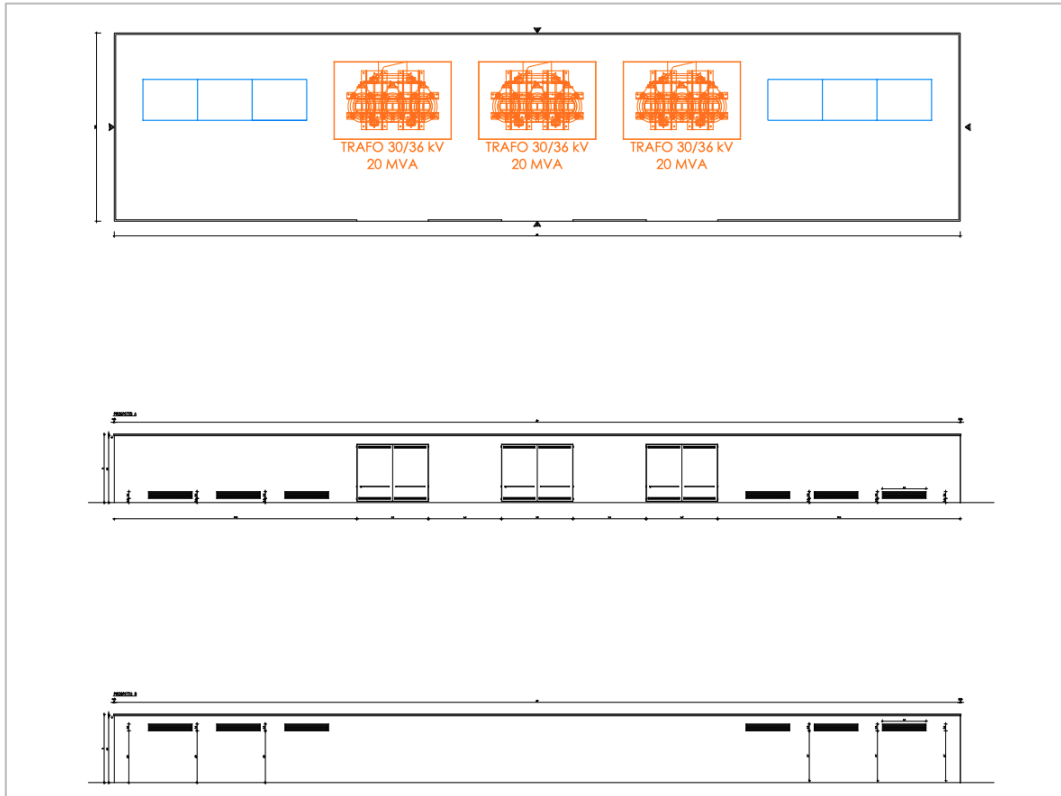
pianta e prospetti della cabina 30/36 kV e storage – progetto iniziale
